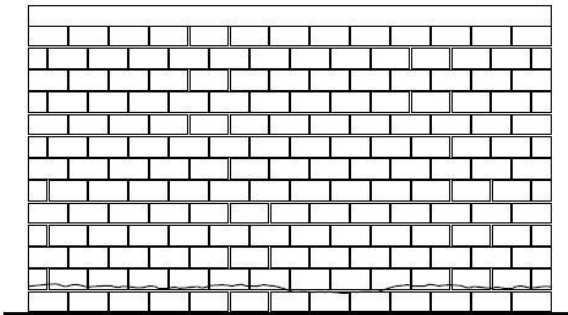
Fissura horizontal por movimentação higroscópica
